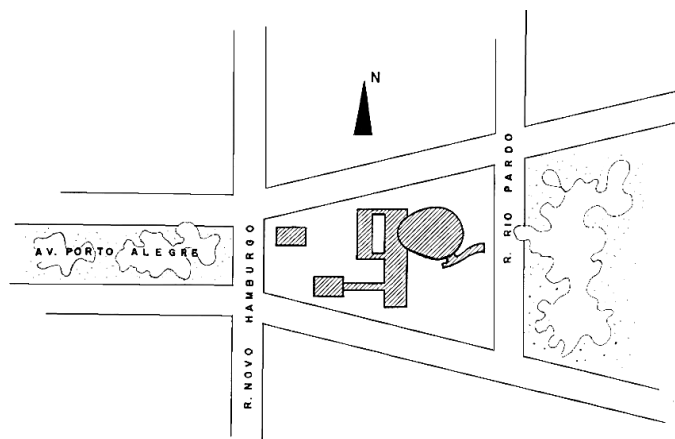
Planta de situação do anteprojeto da SAPI (1951)
